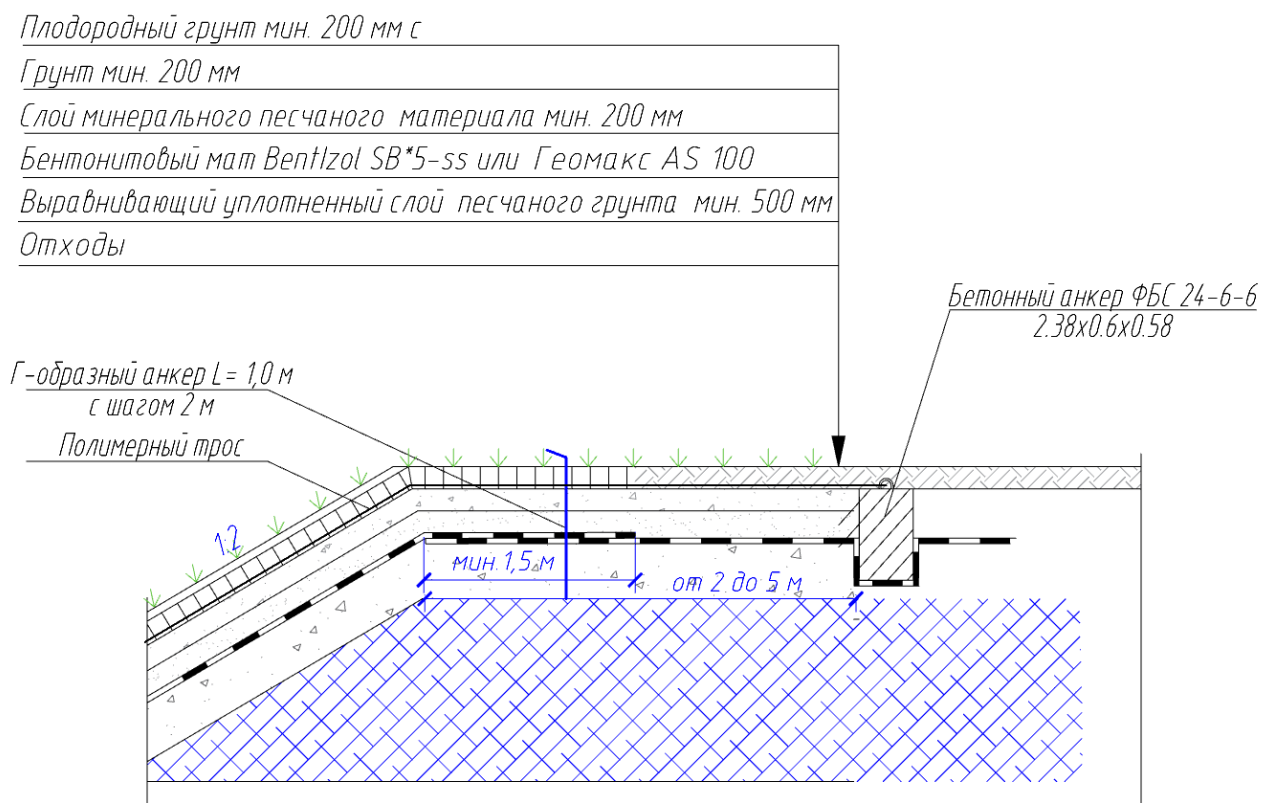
Схема внешней гидроизоляции на вершине откоса.
